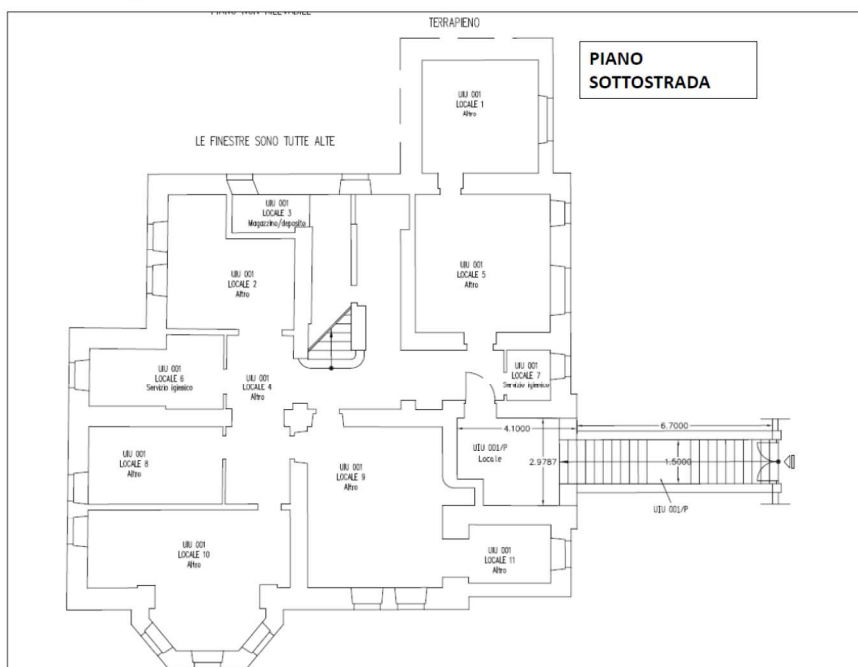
Planimetria Piano Sottrada - Palazzina Liberty di Villa Gruber
